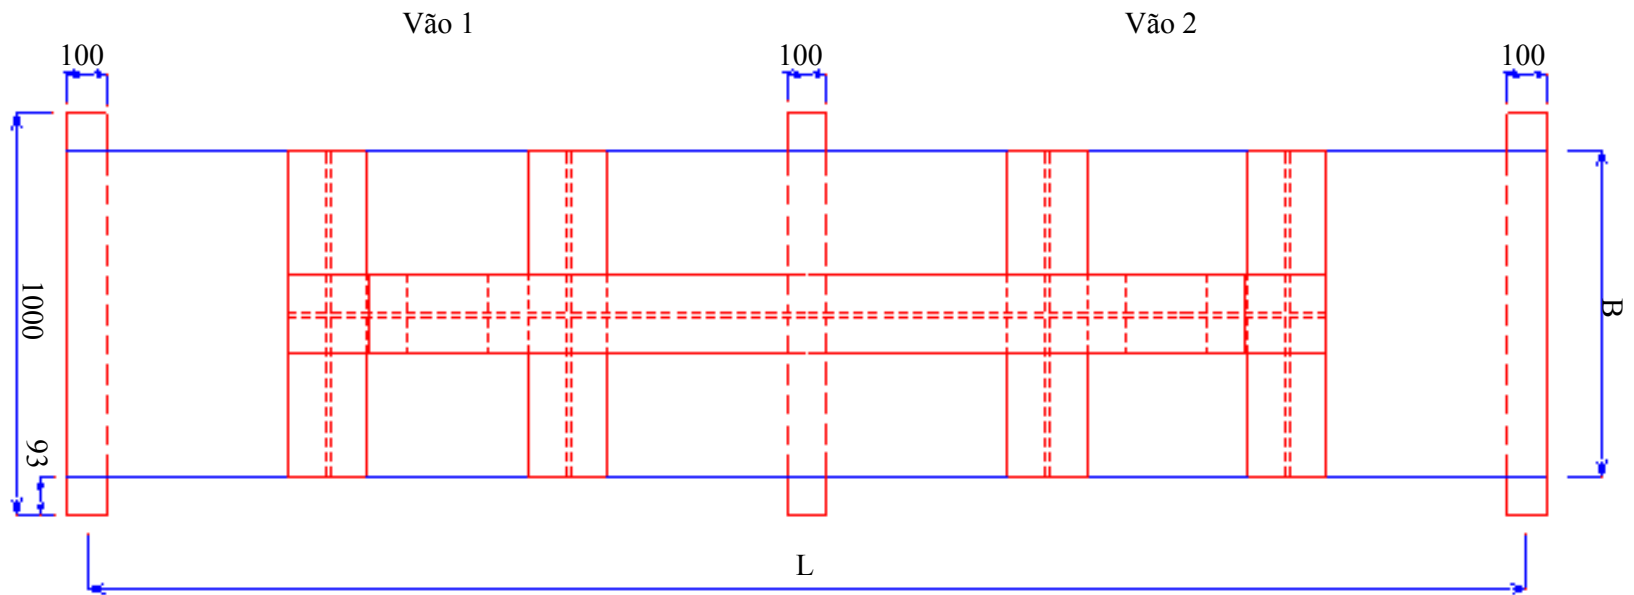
Aparato de carga utilizado nos ensaios da série 2A (medidas em mm) – Vista em Planta
